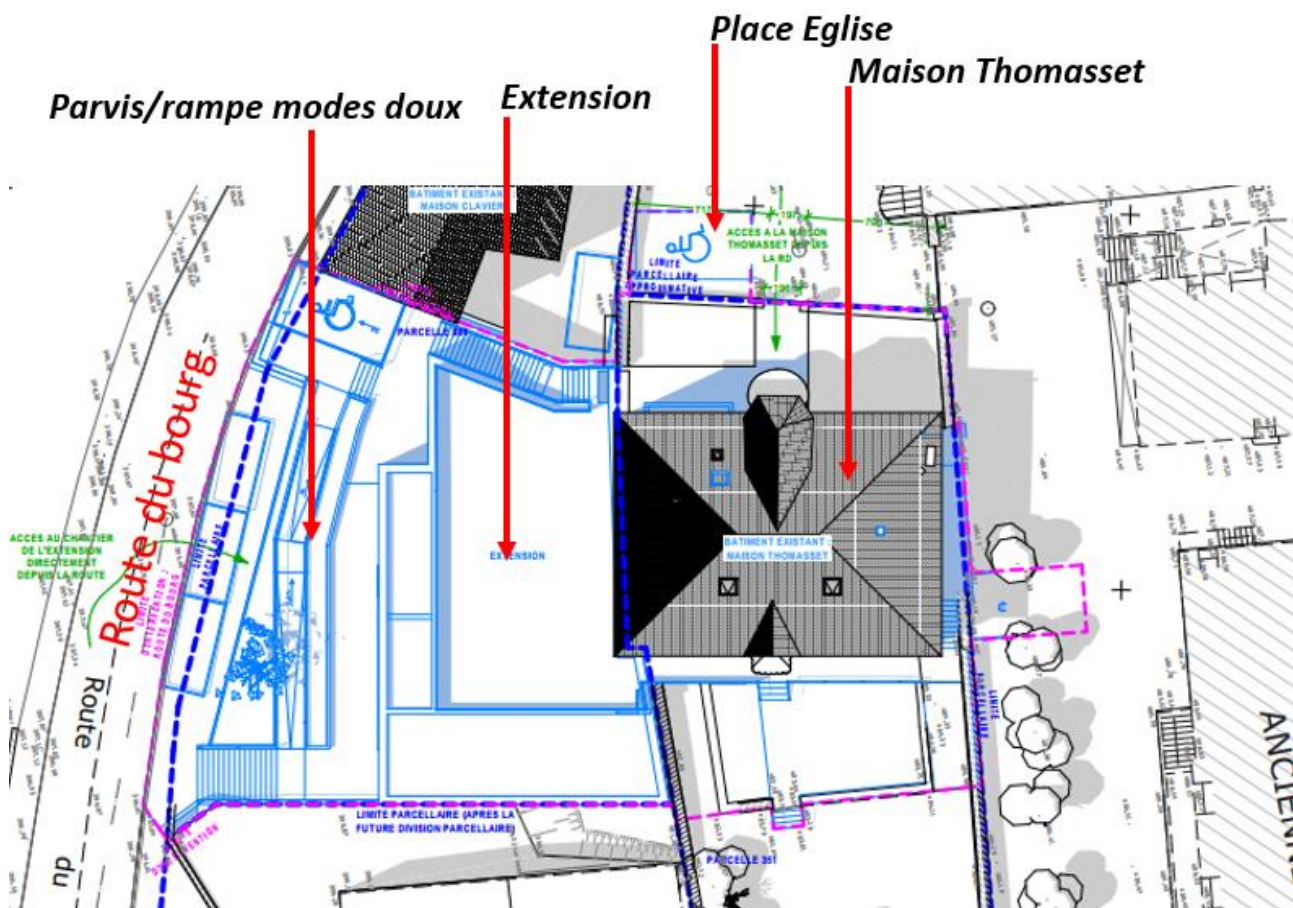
Extrait plan masse du projet. Source : SAMBA Architecture
